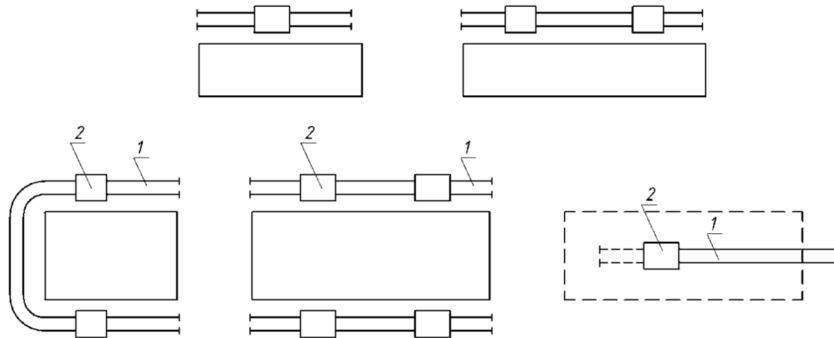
Варіанти розташування монтажних кранів під час монтажу багатоповерхових будівель: 1 – підкрановий шлях; 2 – баштовий кран
